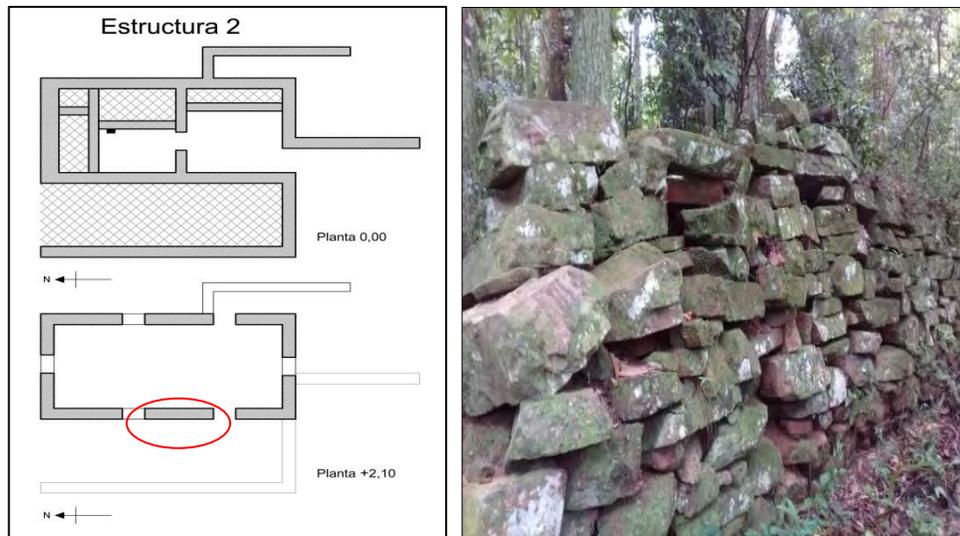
Lugar de extracción de la muestra en la Planta alta de la Estructura II (Fotografía del autor)
